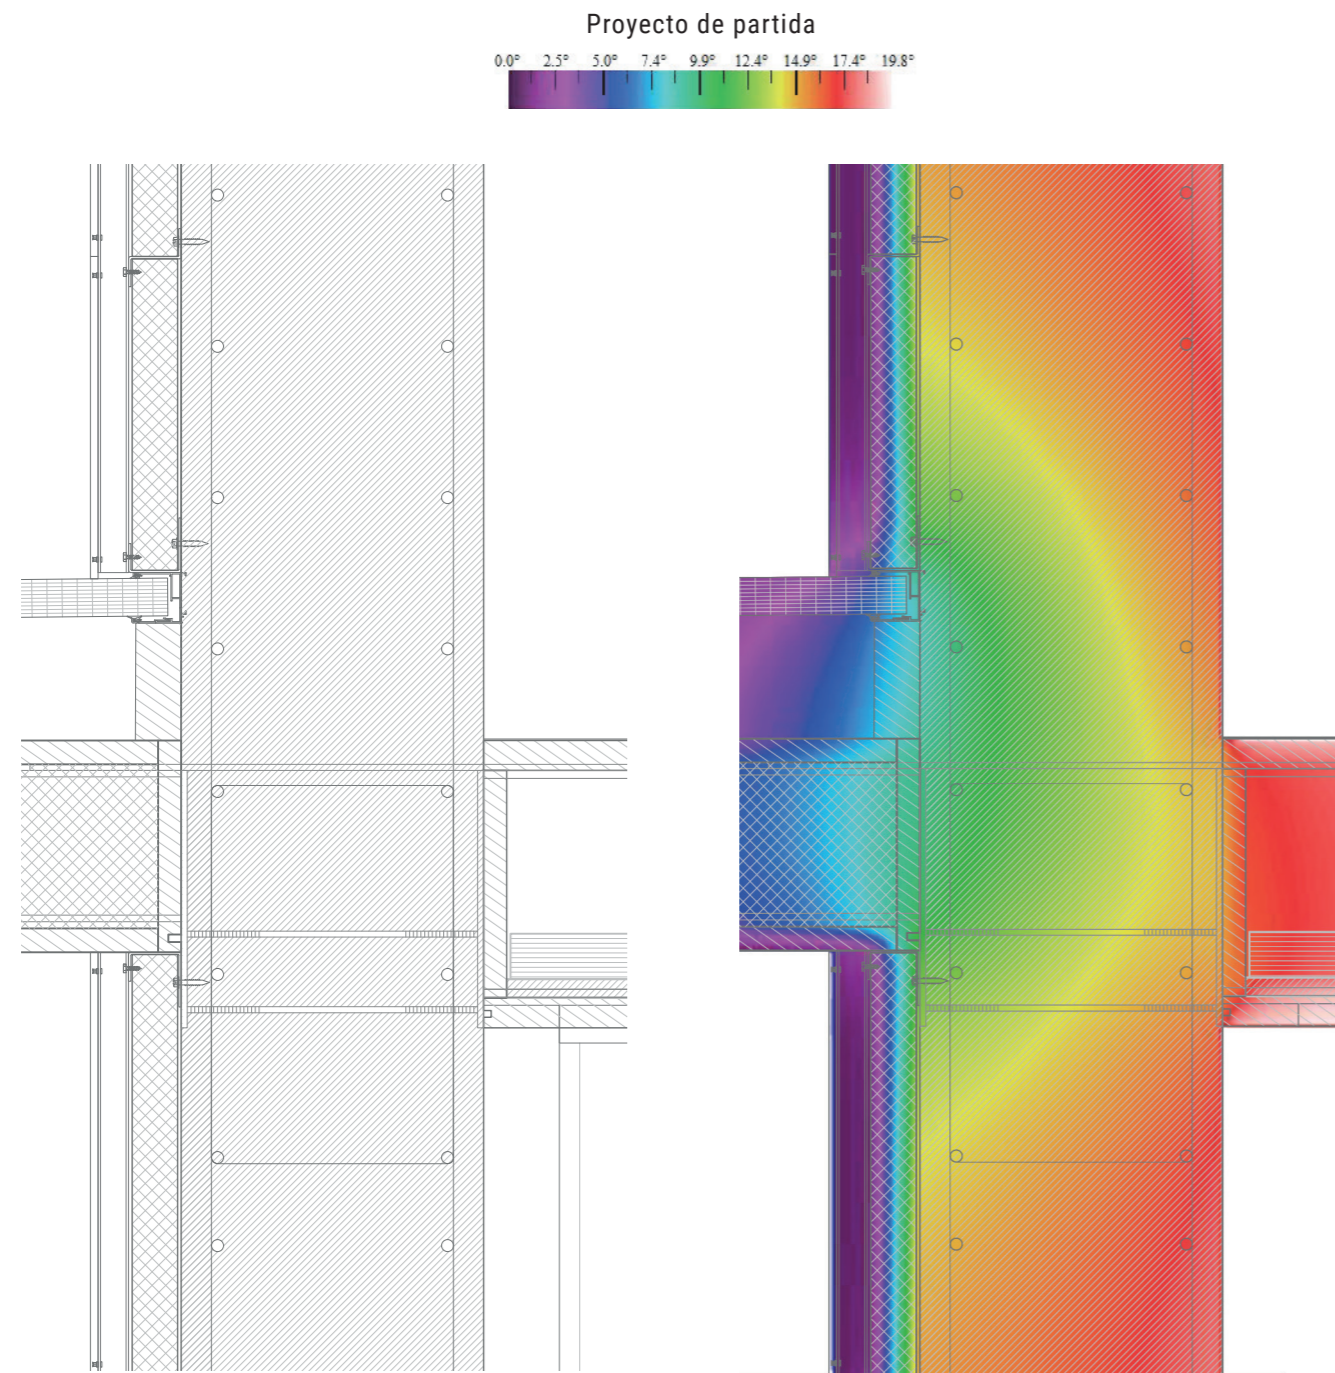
Detalle muro-forjado proyecto de partida E1:10
